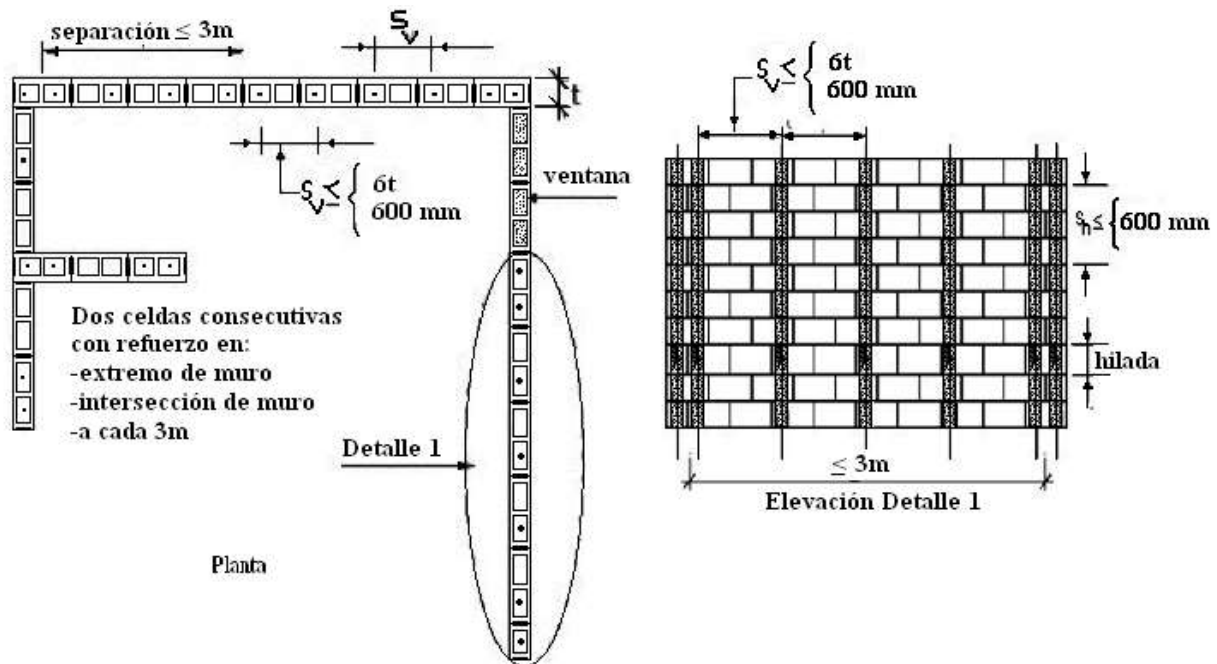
Requisito de refuerzo en paredes de mampostería con refuerzo interior
